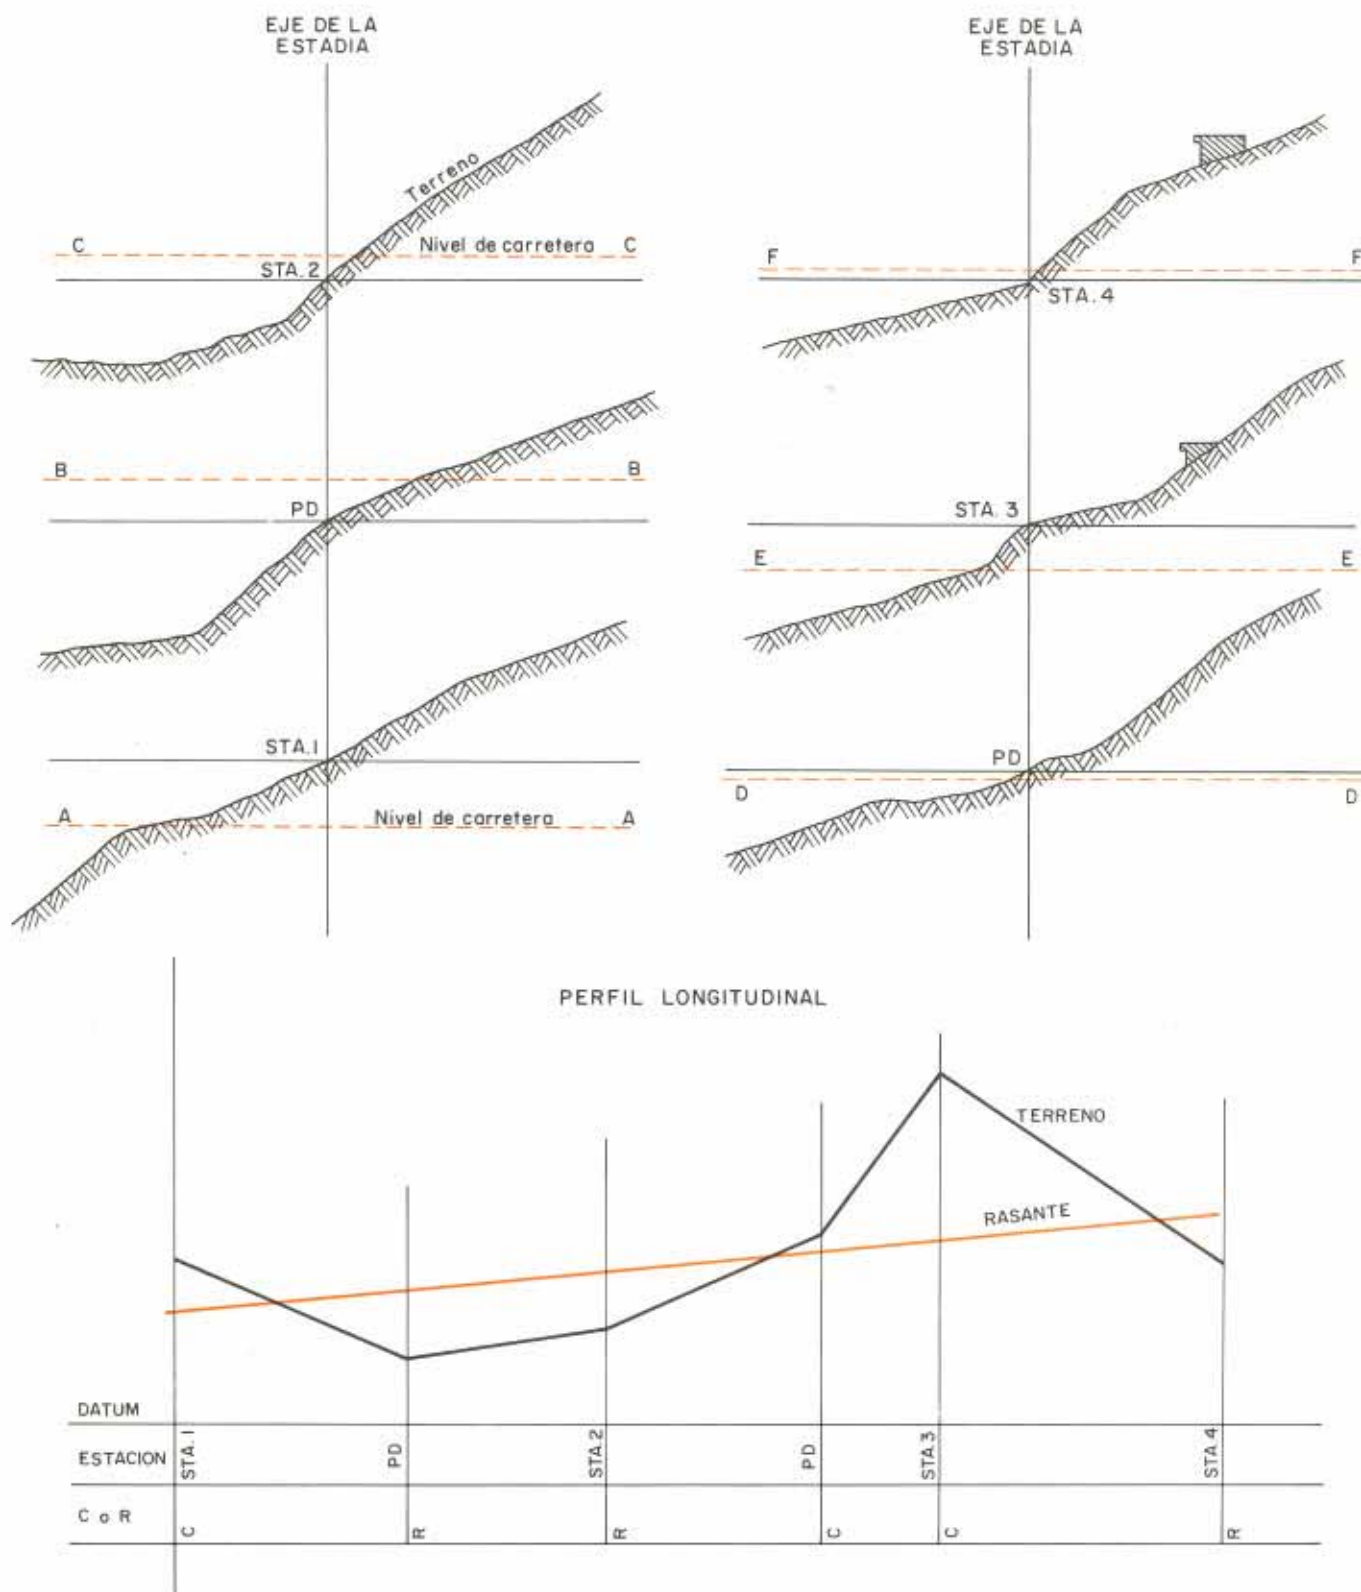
b). Planos del perfil longitudinal y secciones transversales para anteproyectar. Primera aproximación de la rasante.
